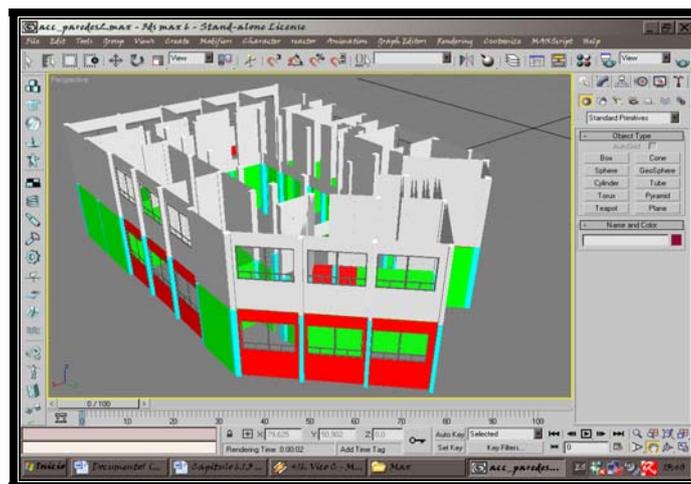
Modelado de la planta alta, junto con la planta baja.
